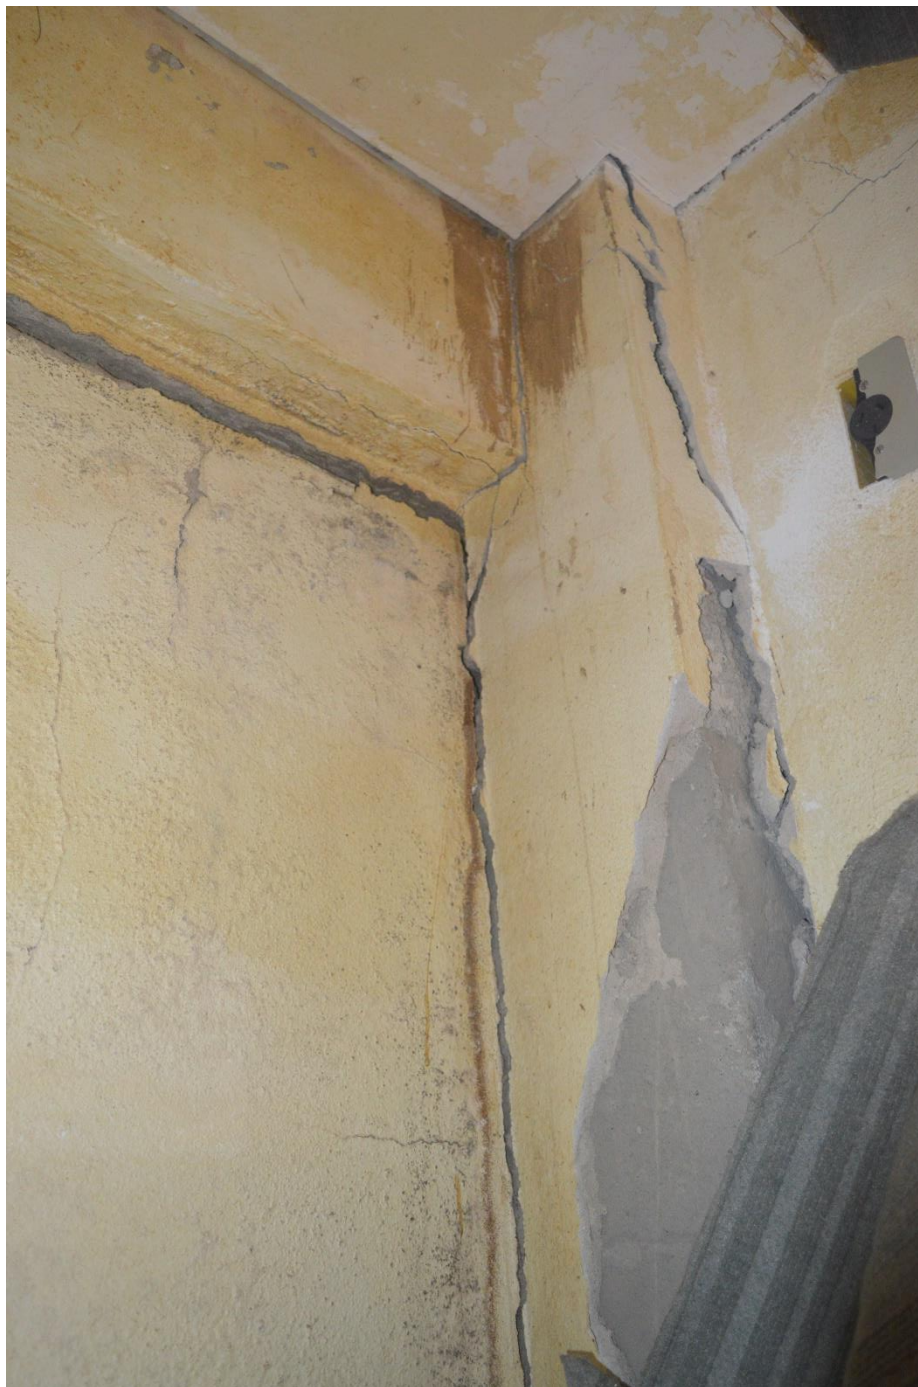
Prédio Anexo - Trincas no pilar e descolamento do painel de alvenaria
